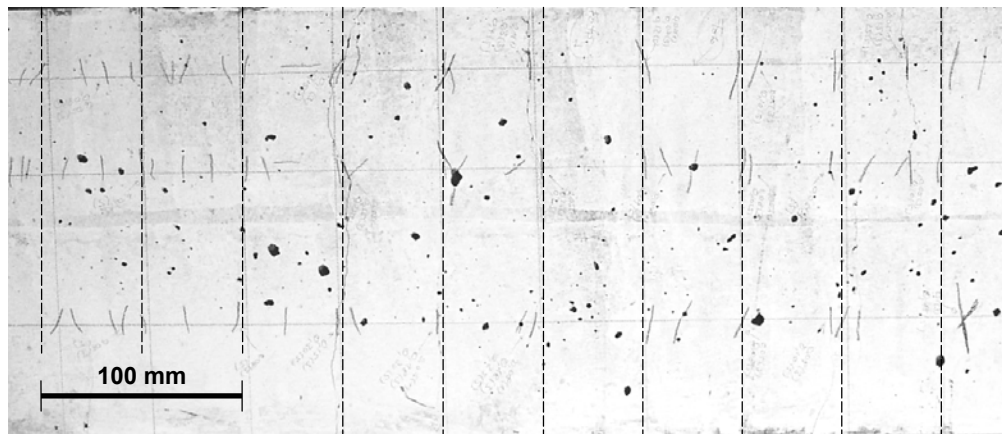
Typisches Rissbild eines Versuchskörpers mit Querbewehrung (Lage der Querstäbe durch gestrichelte Linien gekennzeichnet)
